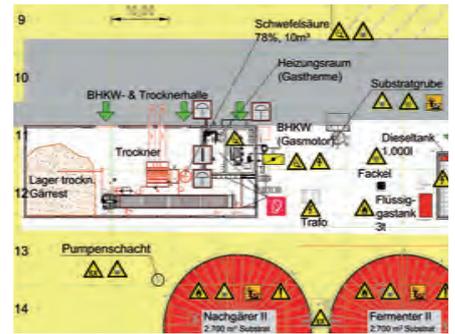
| Ausschnitt aus einem Feuerwehrplan, Quelle: DAS – IB GmbH
